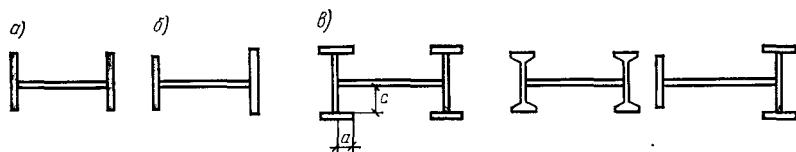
Типы сечений сплошнотенчатых колонн
